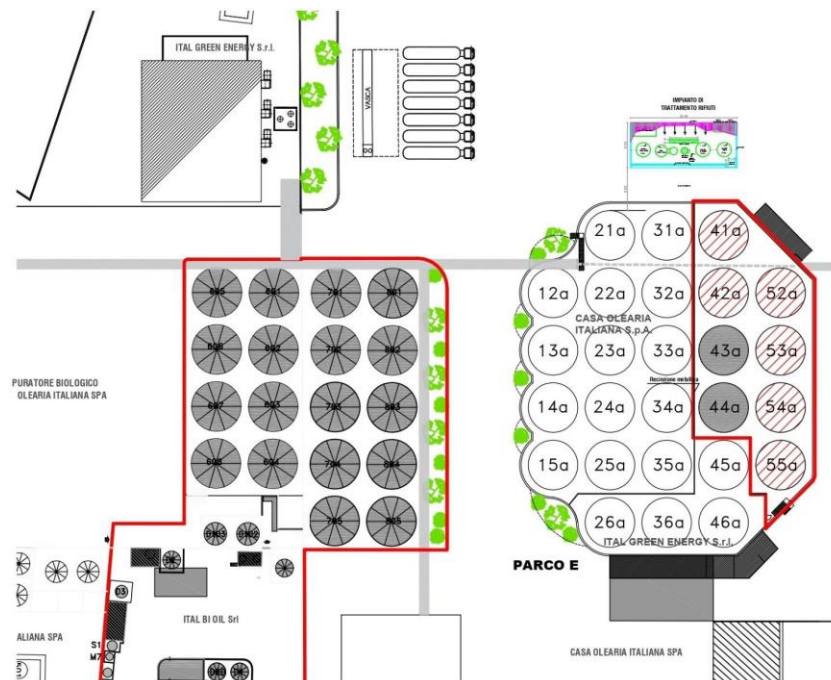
Planimetria impianto con indicazione dei serbatoi di stoccaggio previsti in progetto
